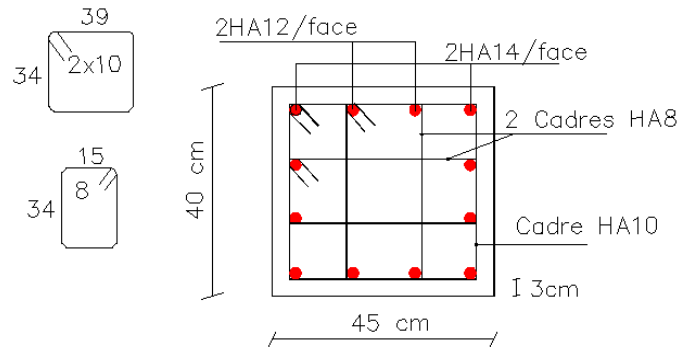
Schéma de ferrailage des poteaux d'étages 7 et 8
